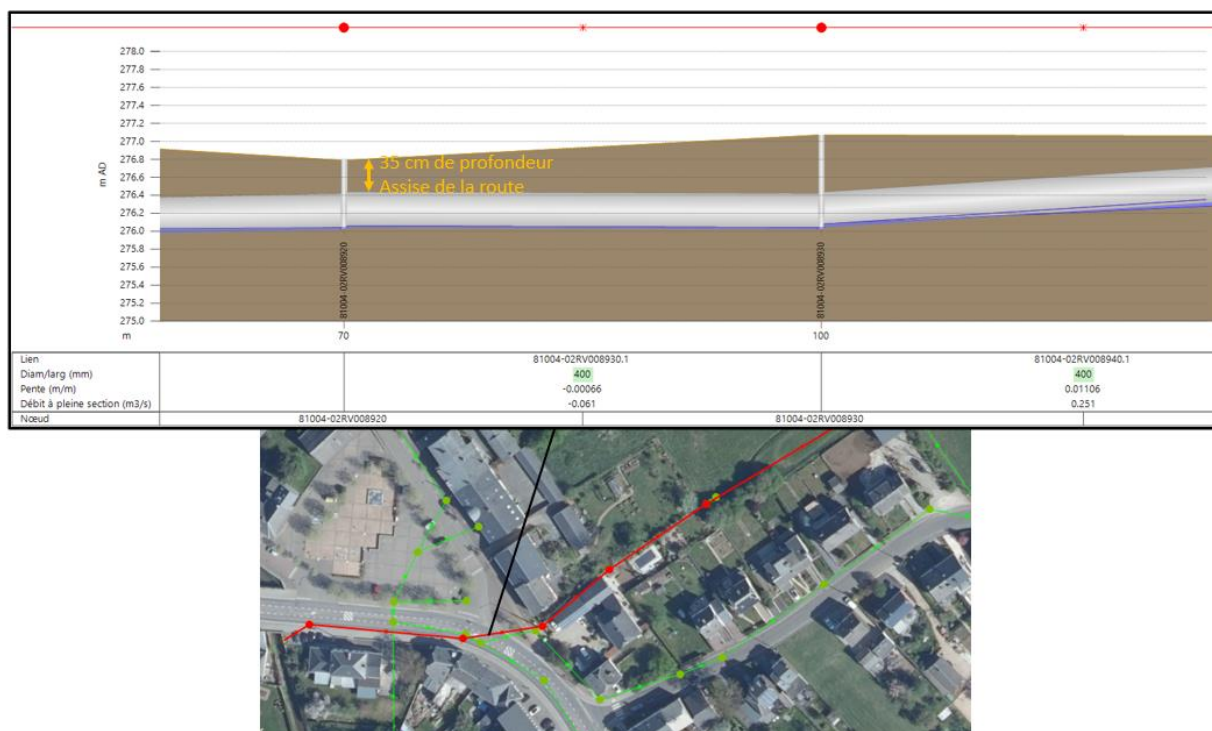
Profil en long de la canalisation traversant la voirie régionale N88 (Rue du Village)
